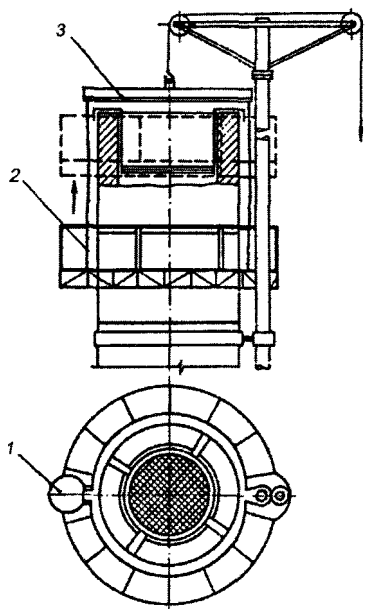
Подъем рабочей площадки при монтаже трубы:
